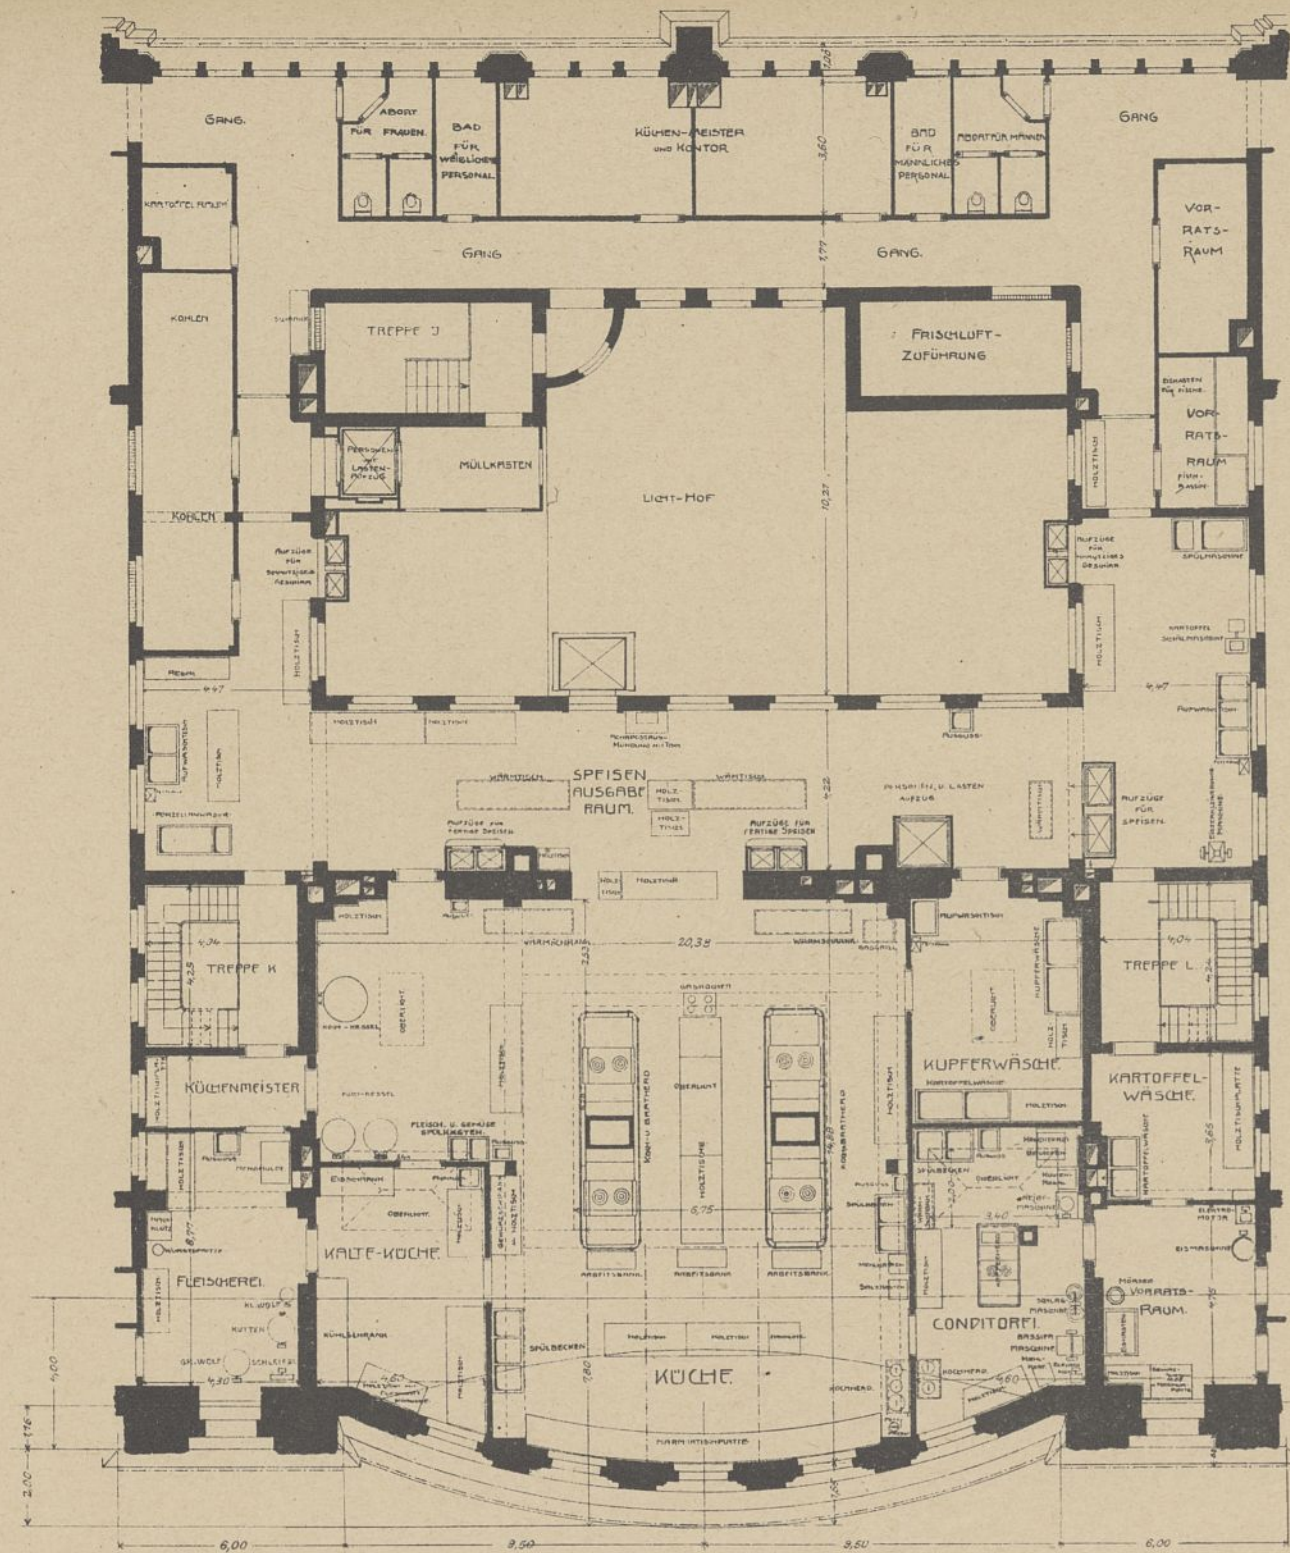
Grundriß der Küchenanlage im Dachgeschoß des Empfangsgebäudes. 1: 200.
